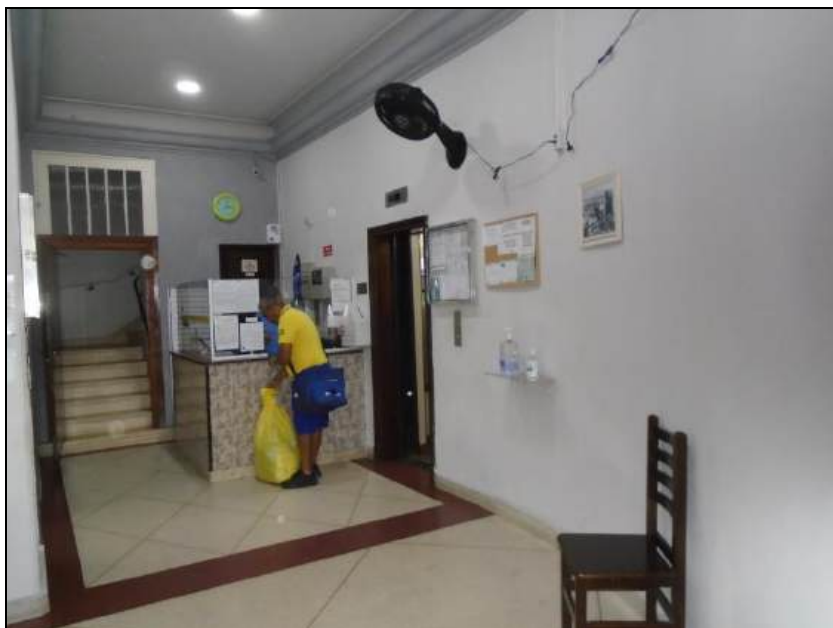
PROJEÇÃO ESCADA E ELEVADOR JUNTO RECEPÇÃO.
